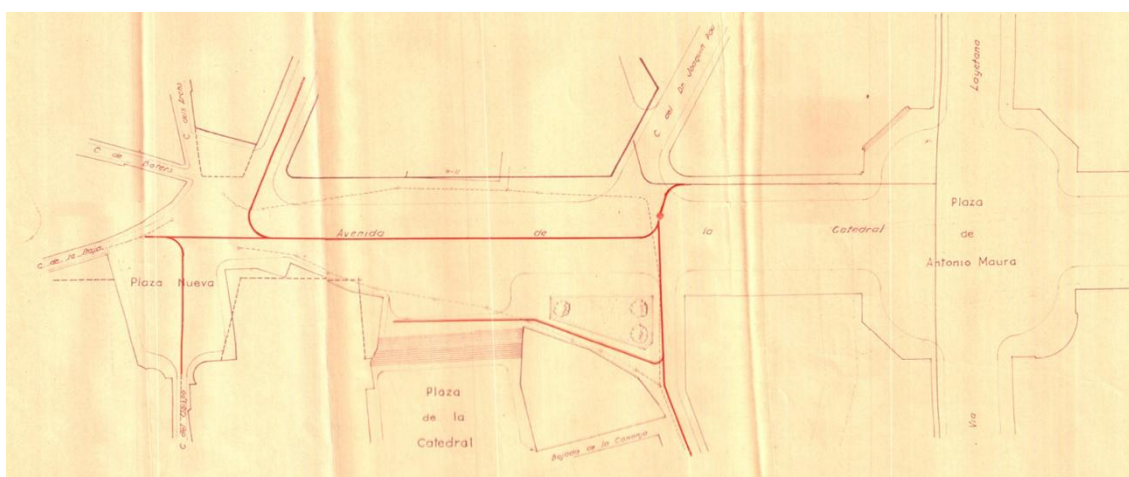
> Red de alcantarillado de la Avenida de la Catedral según el proyecto de 1943 (AMCB.1943).
